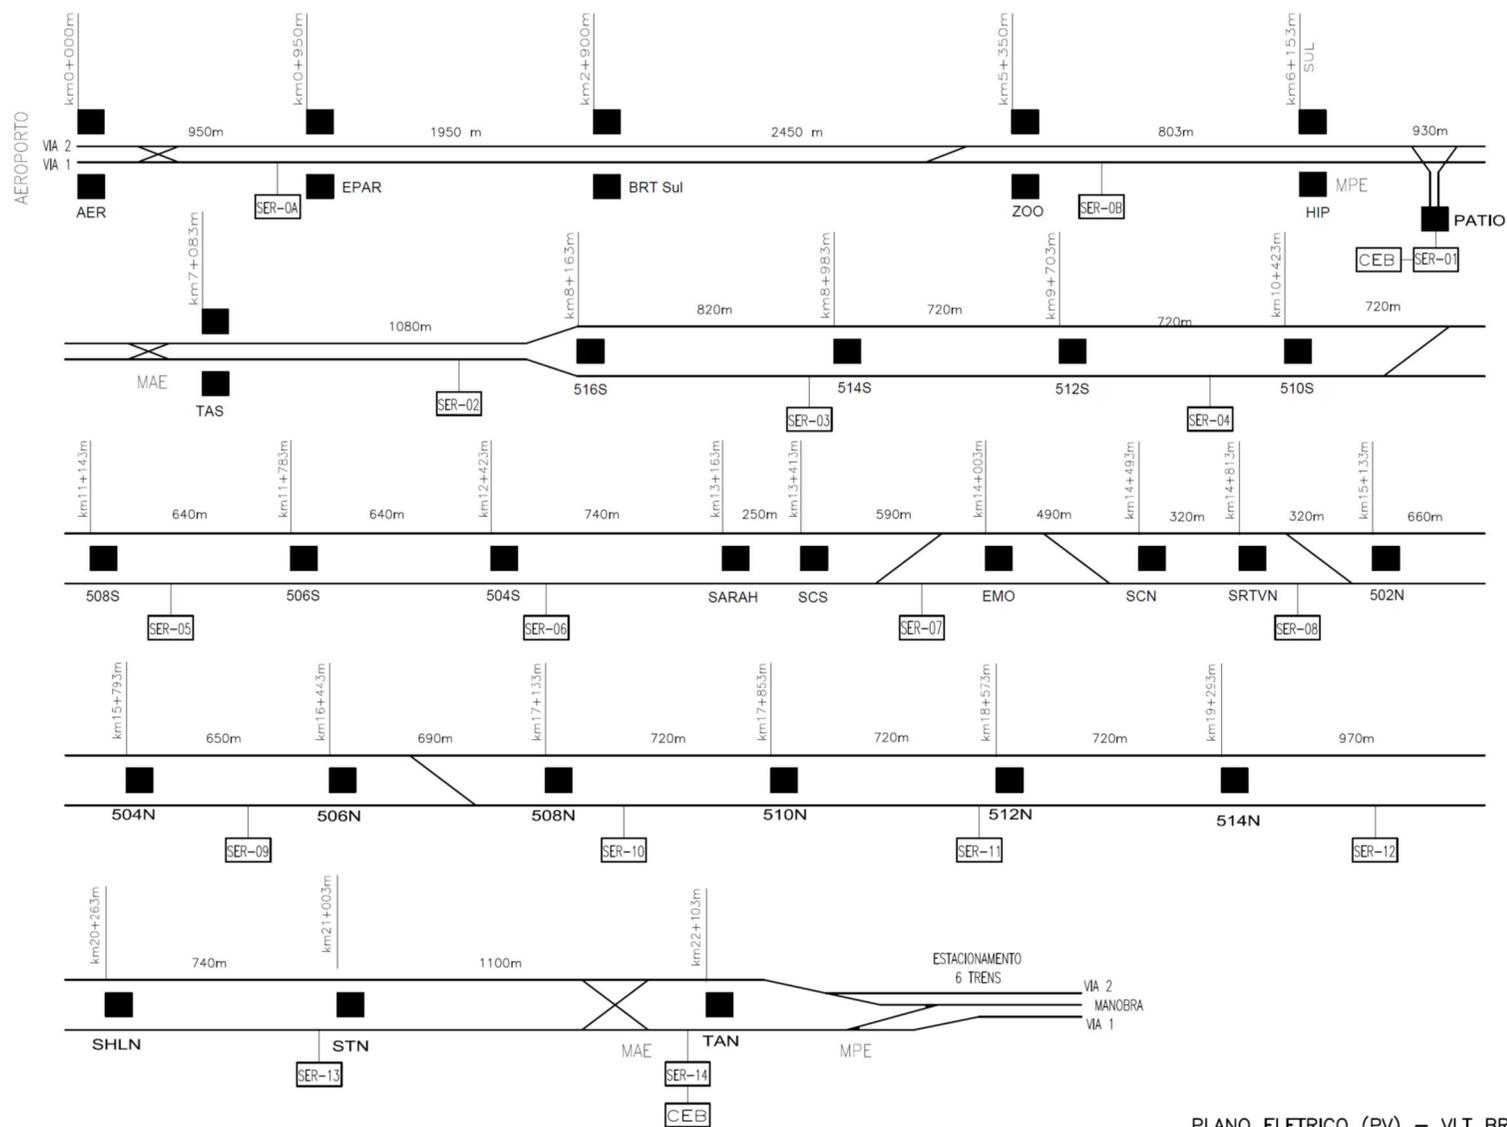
Plano de Vias da Linha 1 – Trecho Hípica – TAN
